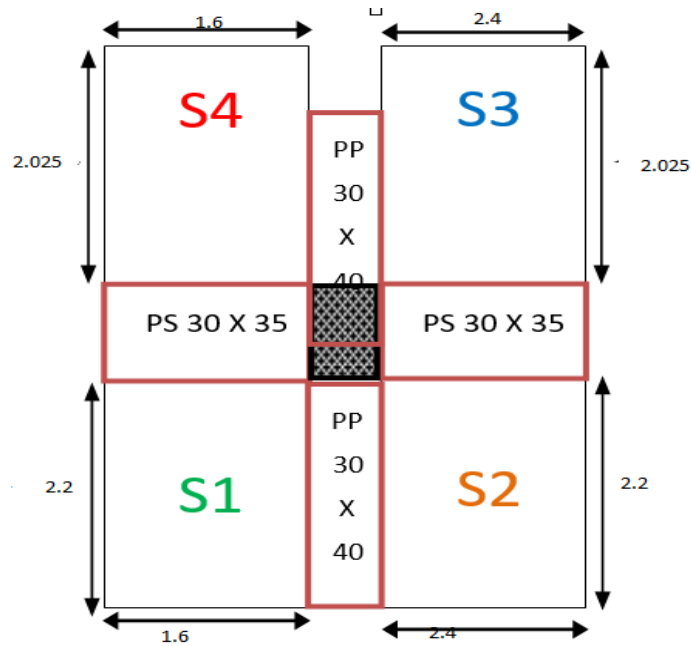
Emplacement du poteau le plus sollicité (sur le plan).
